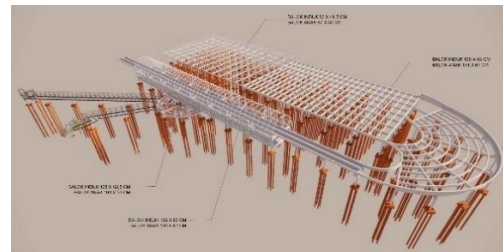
Denah Stasiun LRT Terpadu Lantai 2 dan Depo LRT
